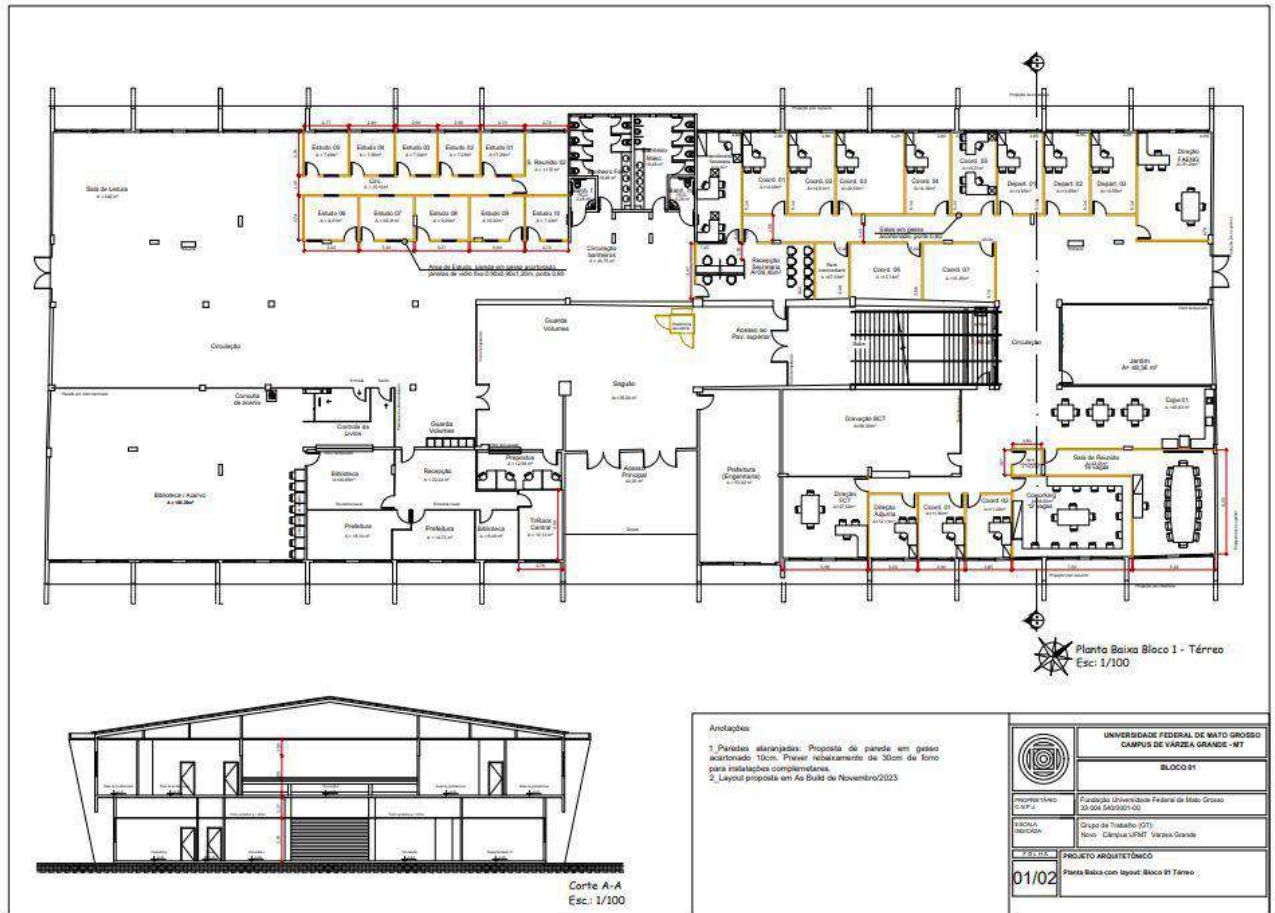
Proposta de projeto preliminar do Bloco 1 pavimento térreo.
